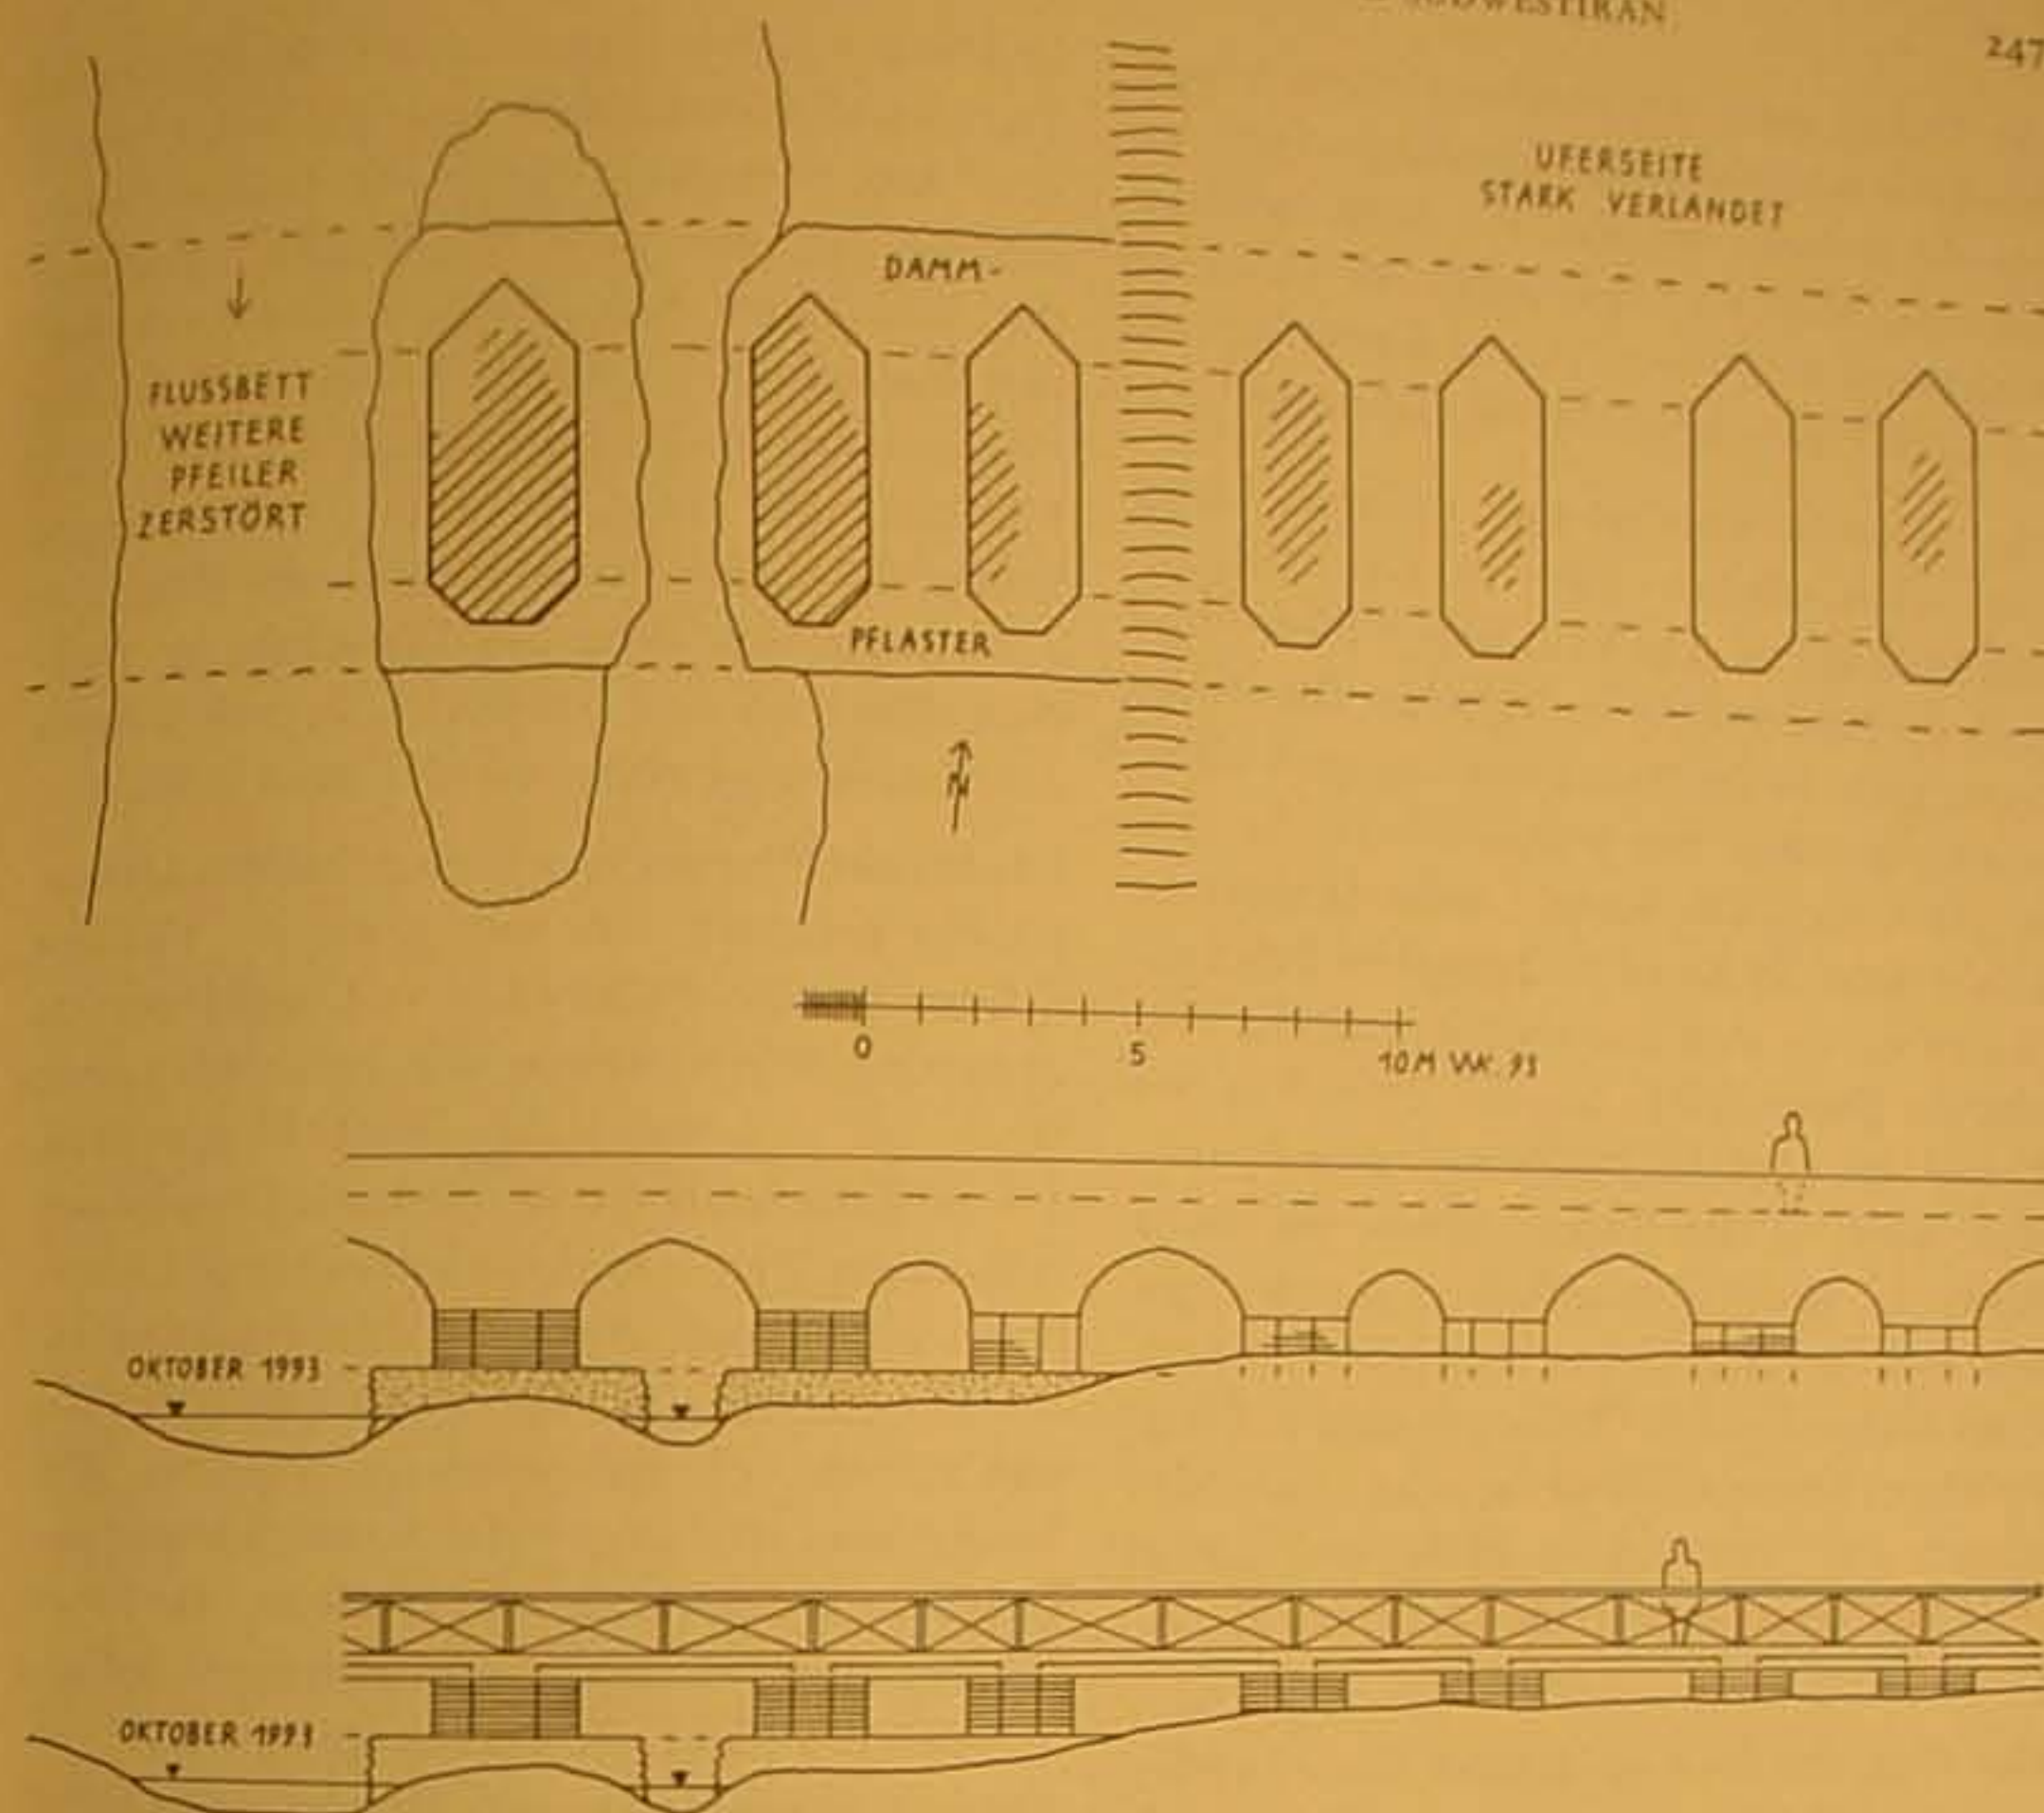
Djondi Shahpur, südliche Brückenreste, Grundriß mit Ergänzung des Aufbaus in Bogenarchitektur und in Holzkonstruktion
